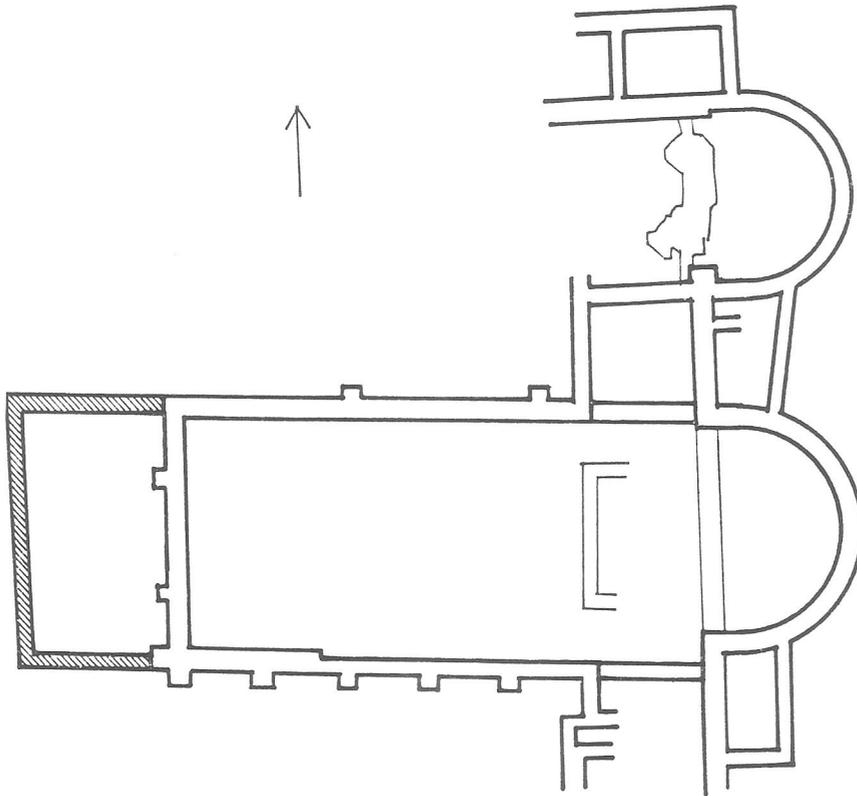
Chiesa sul Doss Trento, planimetria.
